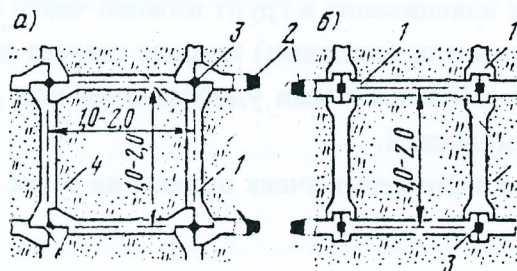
Решетчатое прямоугольное укрепление, прибываемое к откосу земляного полотна железобетонными свайками: а – решетки из одного сборного элемента;
